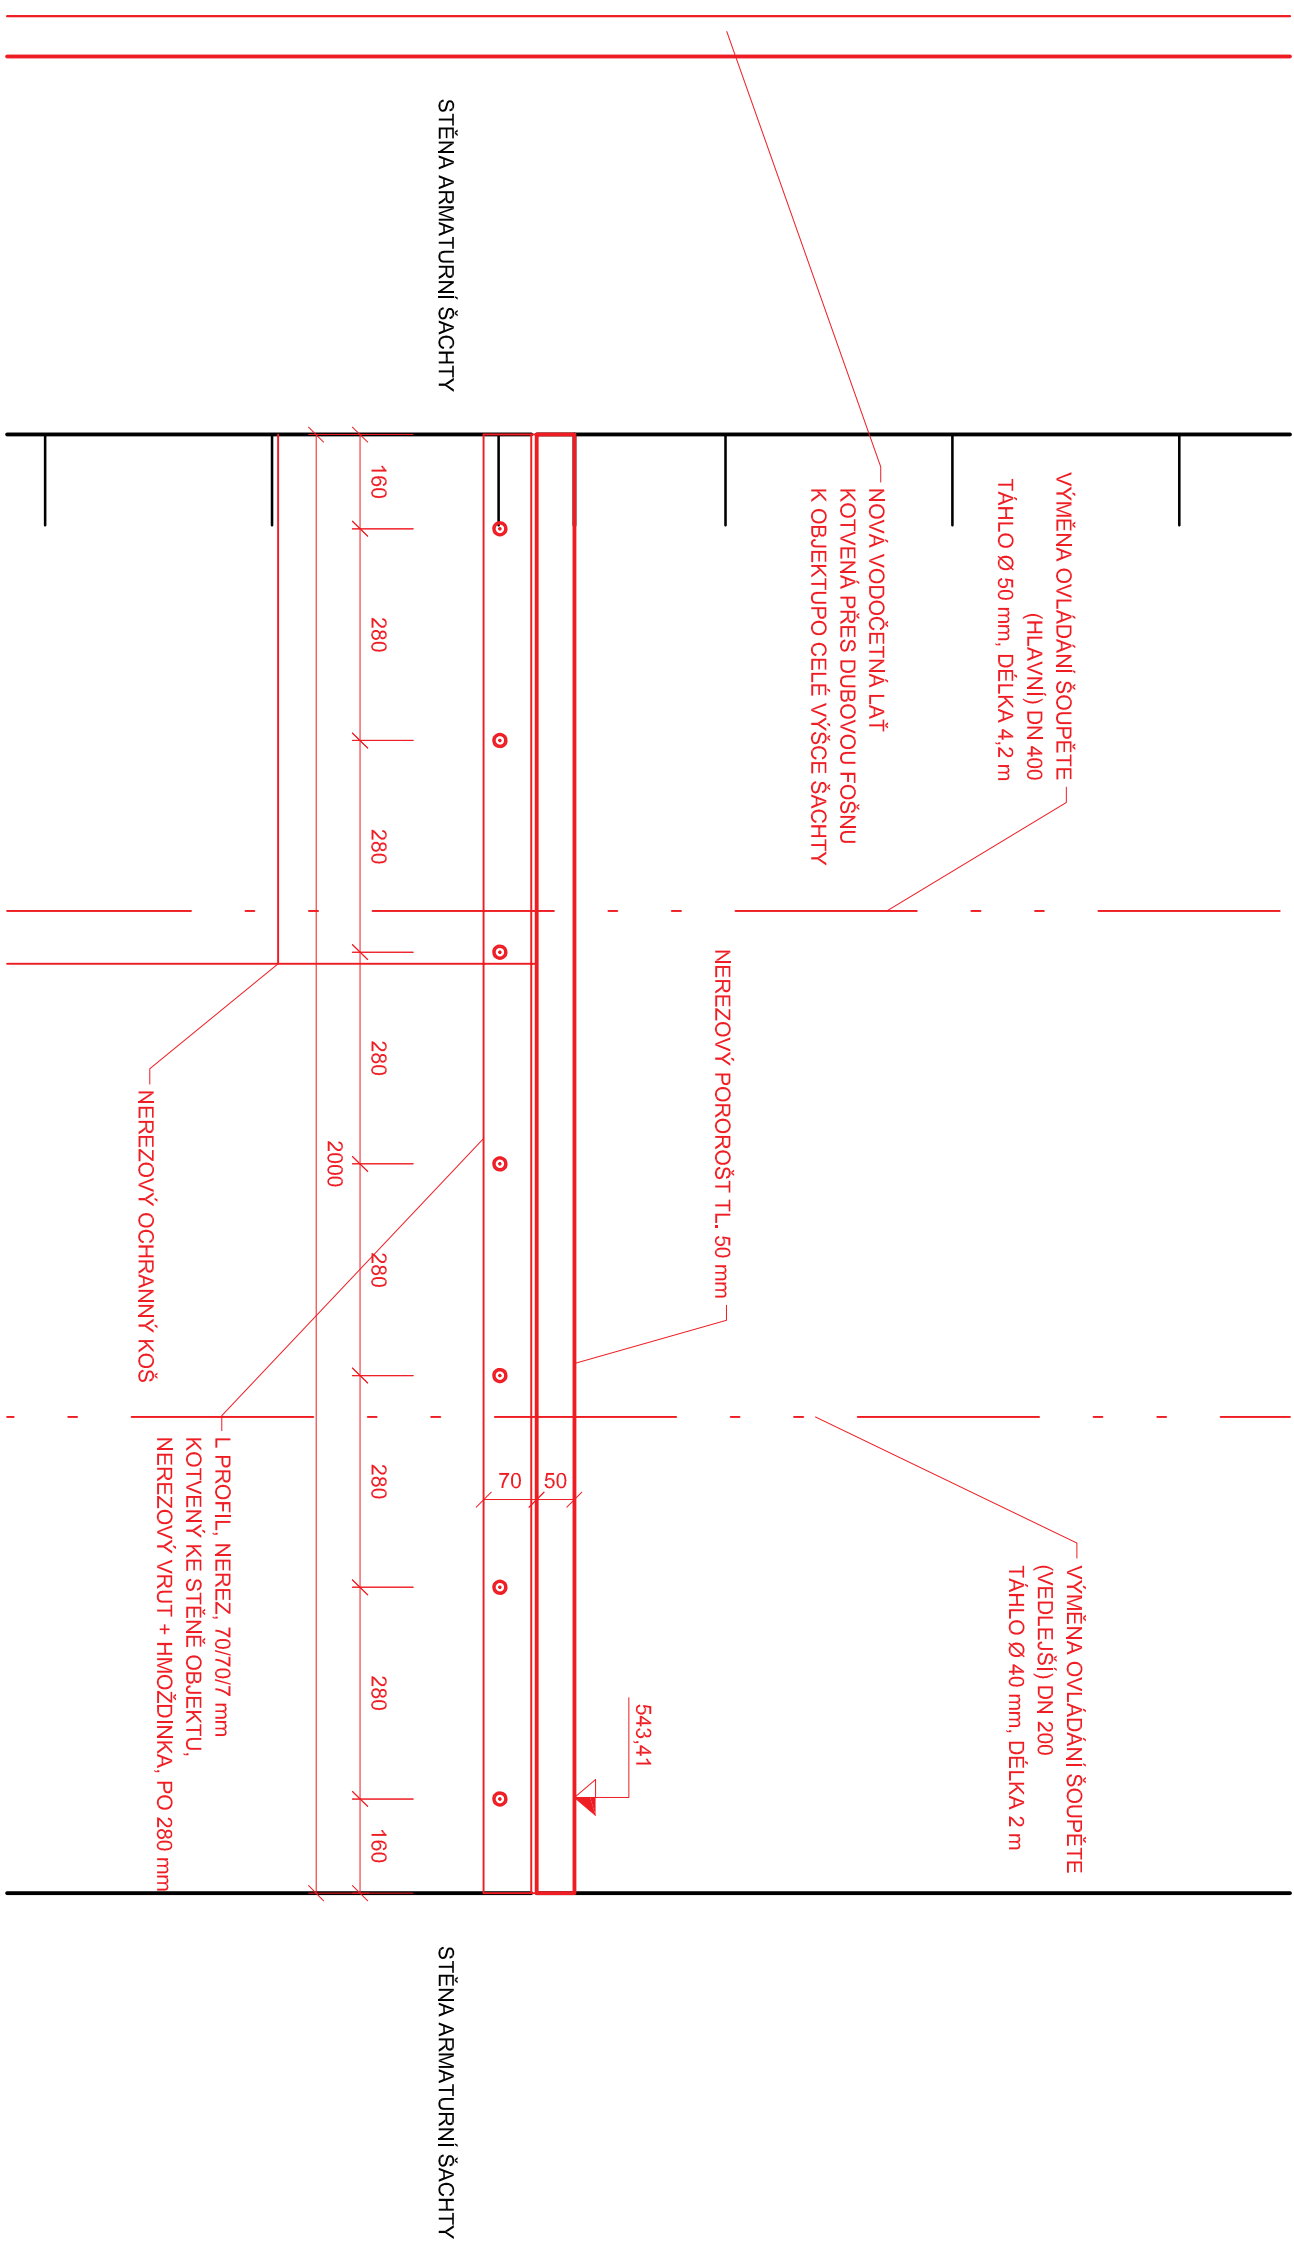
DETAIL ARMATURNÍ ŠACHTY - ŘEZ A2-A2
